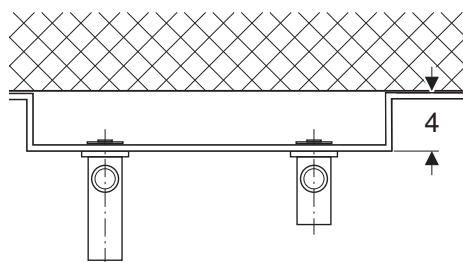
Dimensões de montagem para montagem exterior com a placa de montagem Geberit
